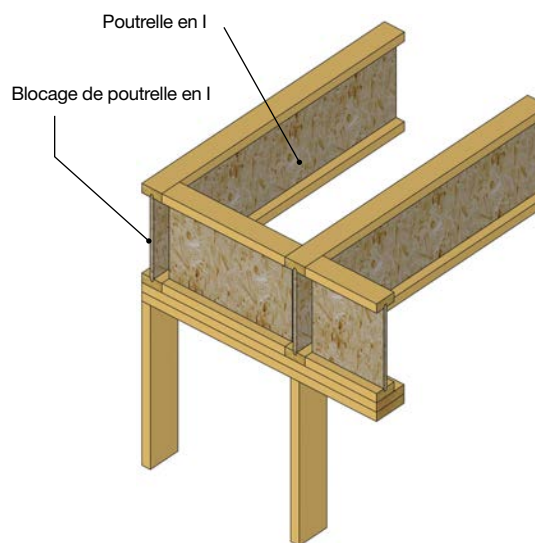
• Blocage de poutrelle en I appuyée par la semelle inférieure
